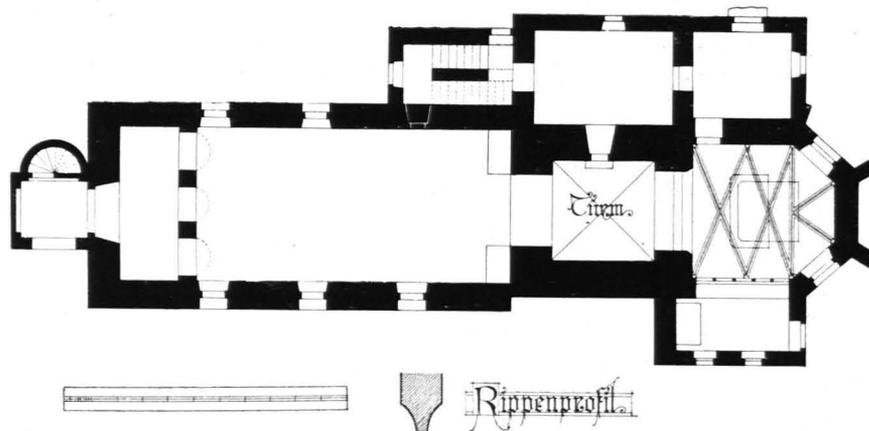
Kirchberg a. d. Wild, Pfarrkirche, Grundriß 1:300 (S. 147)
